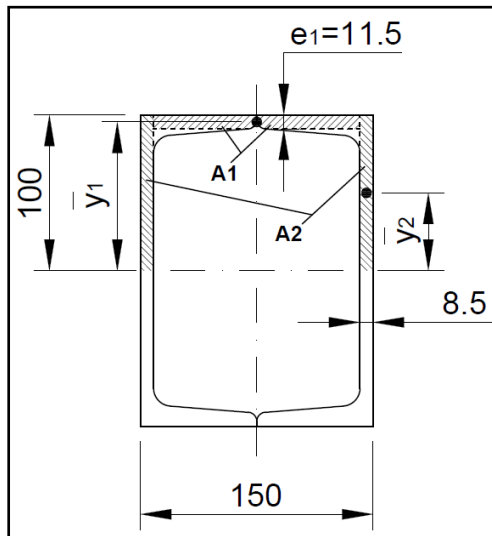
Dimensiones de la sección de las columnas del pórtico – Perfiles 2 y 3.
